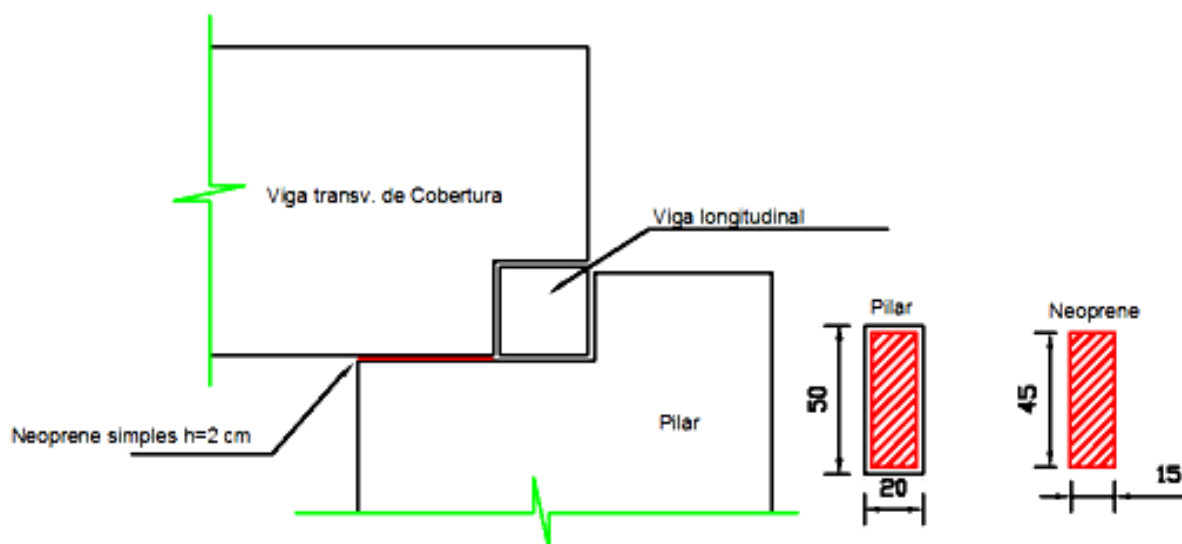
Aparelho de neoprene simples dimensionado para as vigas de cobertura do ICC (Autocad, 2007).
